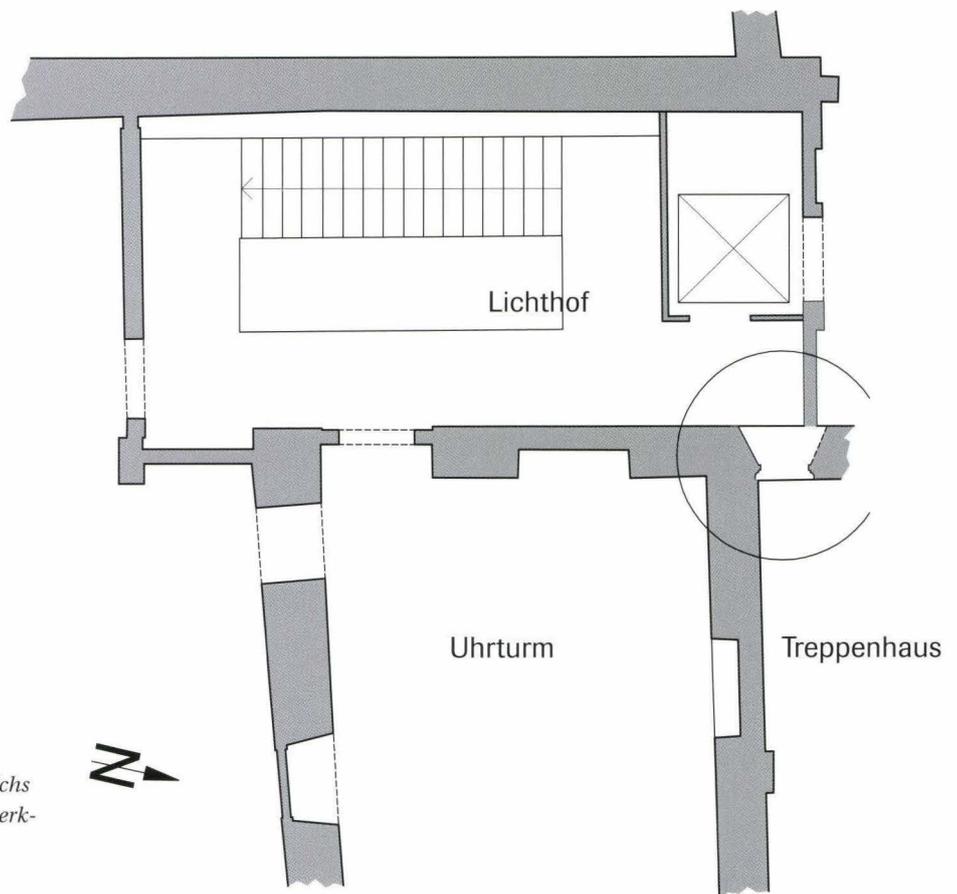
Lohnhof. Grundriss des Bereichs beim Lichthof, mit der Lage des Masswerkfensters (Kreis). – Zeichnung: Matthias Merki.
